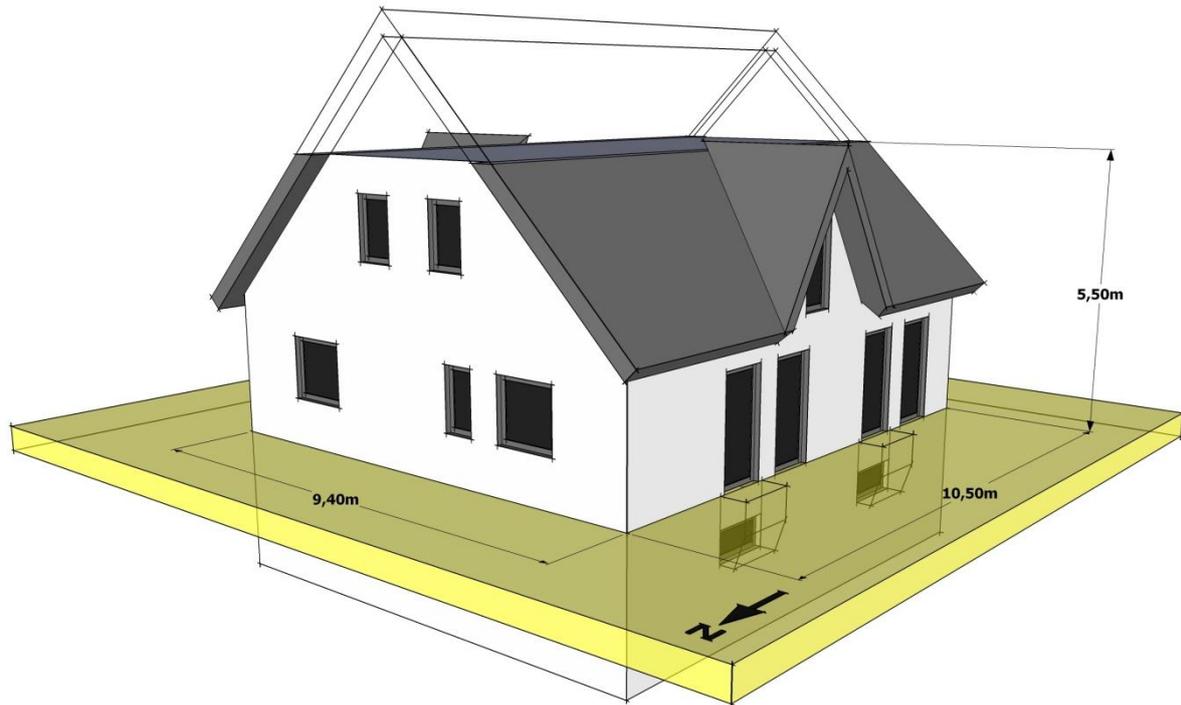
Einfamilienhaus klein mit Keller – Ansicht Nord-West
